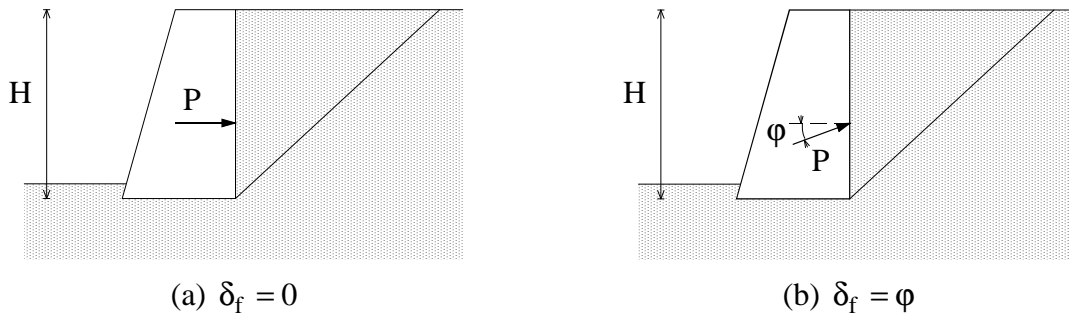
Poussée sur un mur à paroi verticale : cas du massif à surface horizontale.
